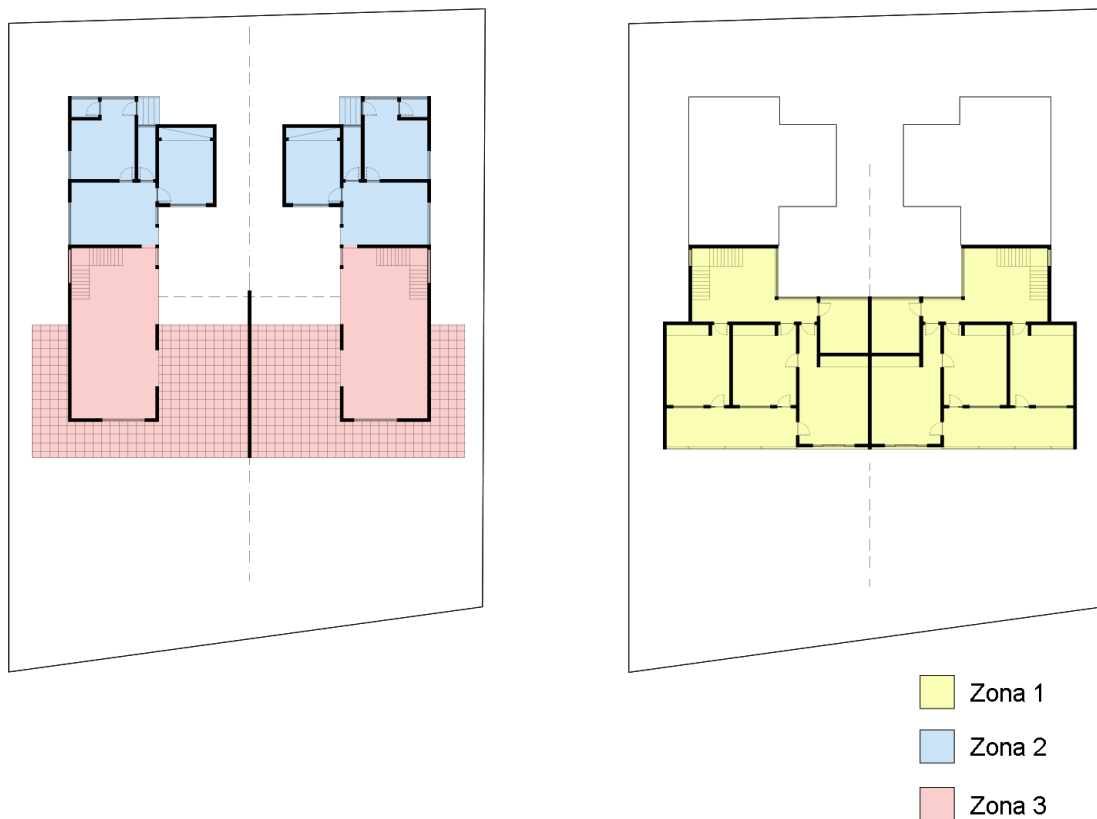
Planta baixa do térreo e do primeiro pavimento com as zonas 1, 2 e 3 delimitadas na planta baixa das casas. Fonte: 1ª Regional da Prefeitura do Recife, 1958. Editado pelas autoras.
